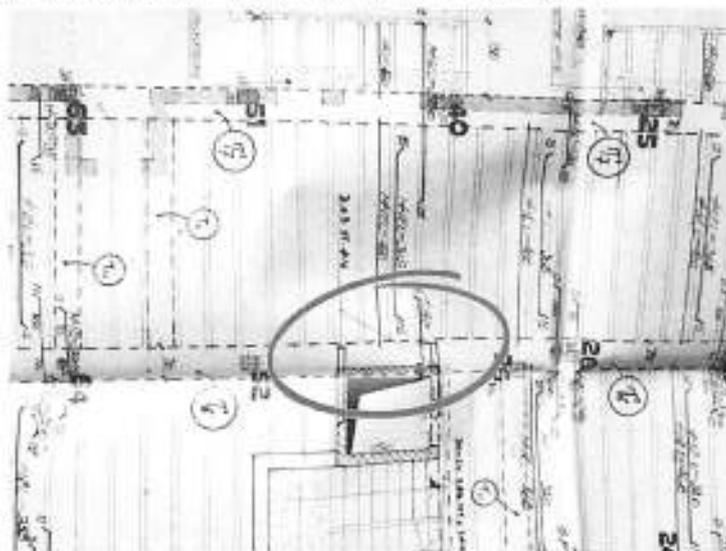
TAV. 3 – pianta (particolare intorno al vano ascensore)
